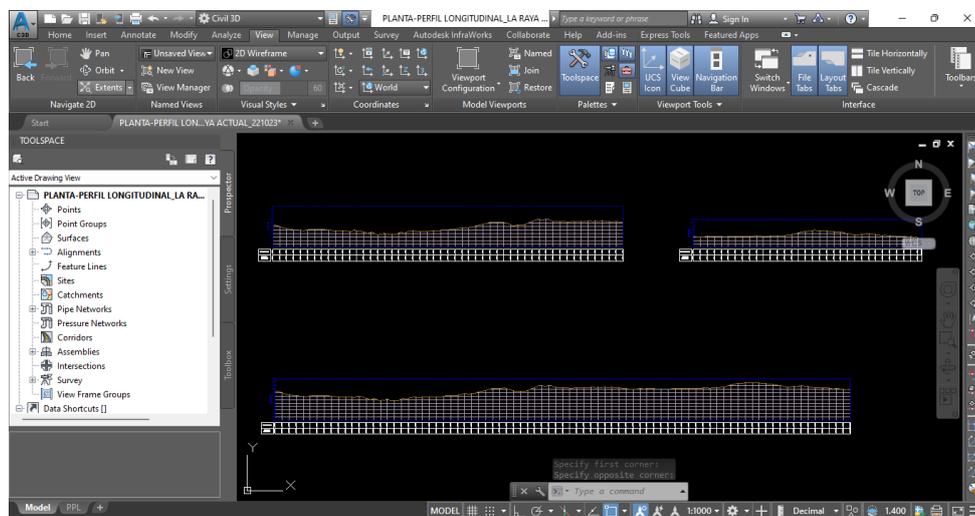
Trazo de Perfiles longitudinales y Secciones Transversales
